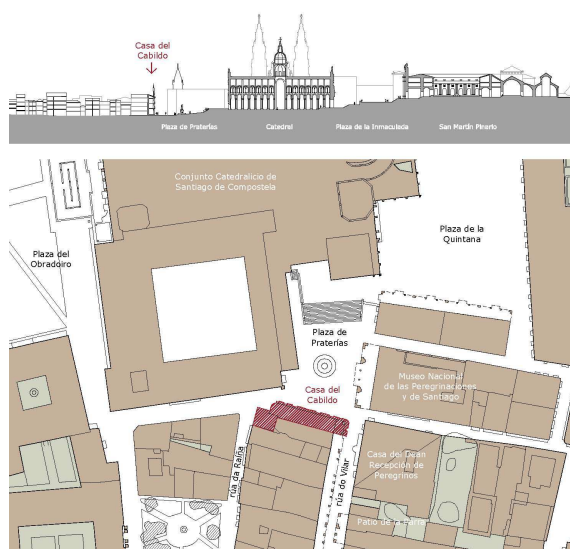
Planta de situación e sección, do entorno da Casa do Cabildo.
